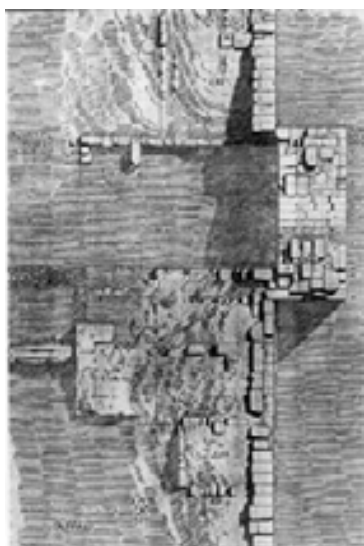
Paestum, *Veduta dall'alto con planimetria
